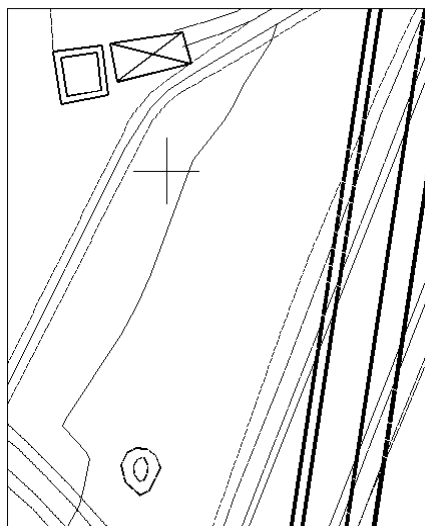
Pormenor Planta Ramo 4, condicionantes de ocupação do solo
